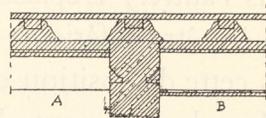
Plancher avec solives assemblées dans les poutres.
